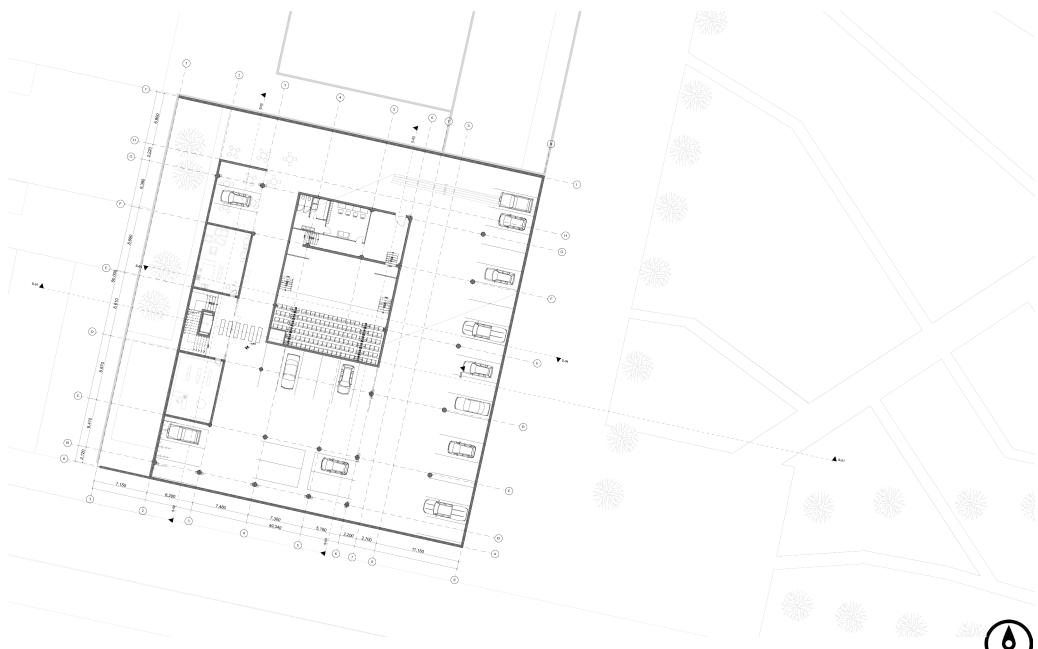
Planta nivel -2 Estacionamientos, sujeta a cambios. Fuente: elaboración propia. ESCALA 1:500
